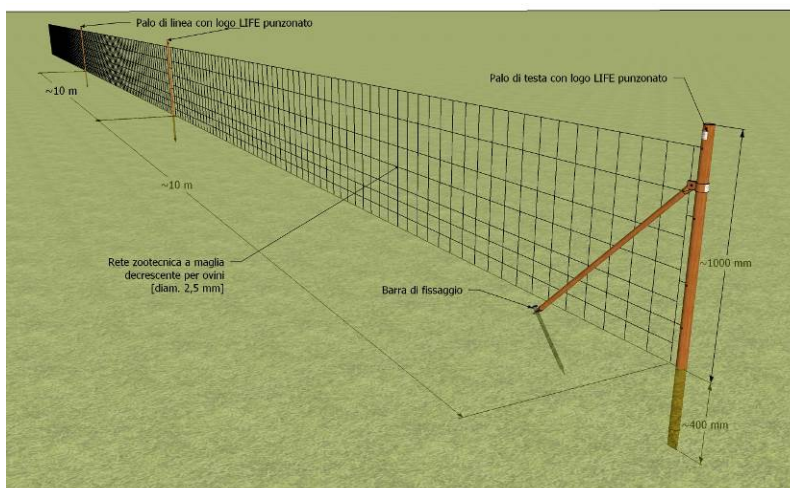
Schema di installazione della recinzione a rete fissa con angolo controventato come prevista nel progetto LIFE Xero-grazing.
